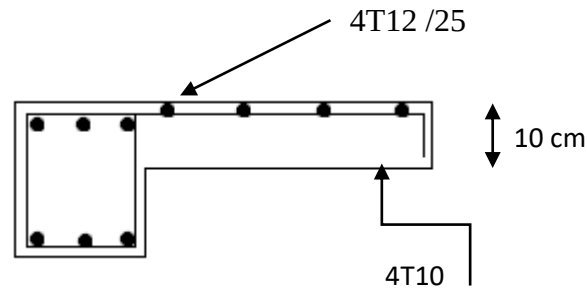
Ferrailage du premier et deuxième type de balcon
